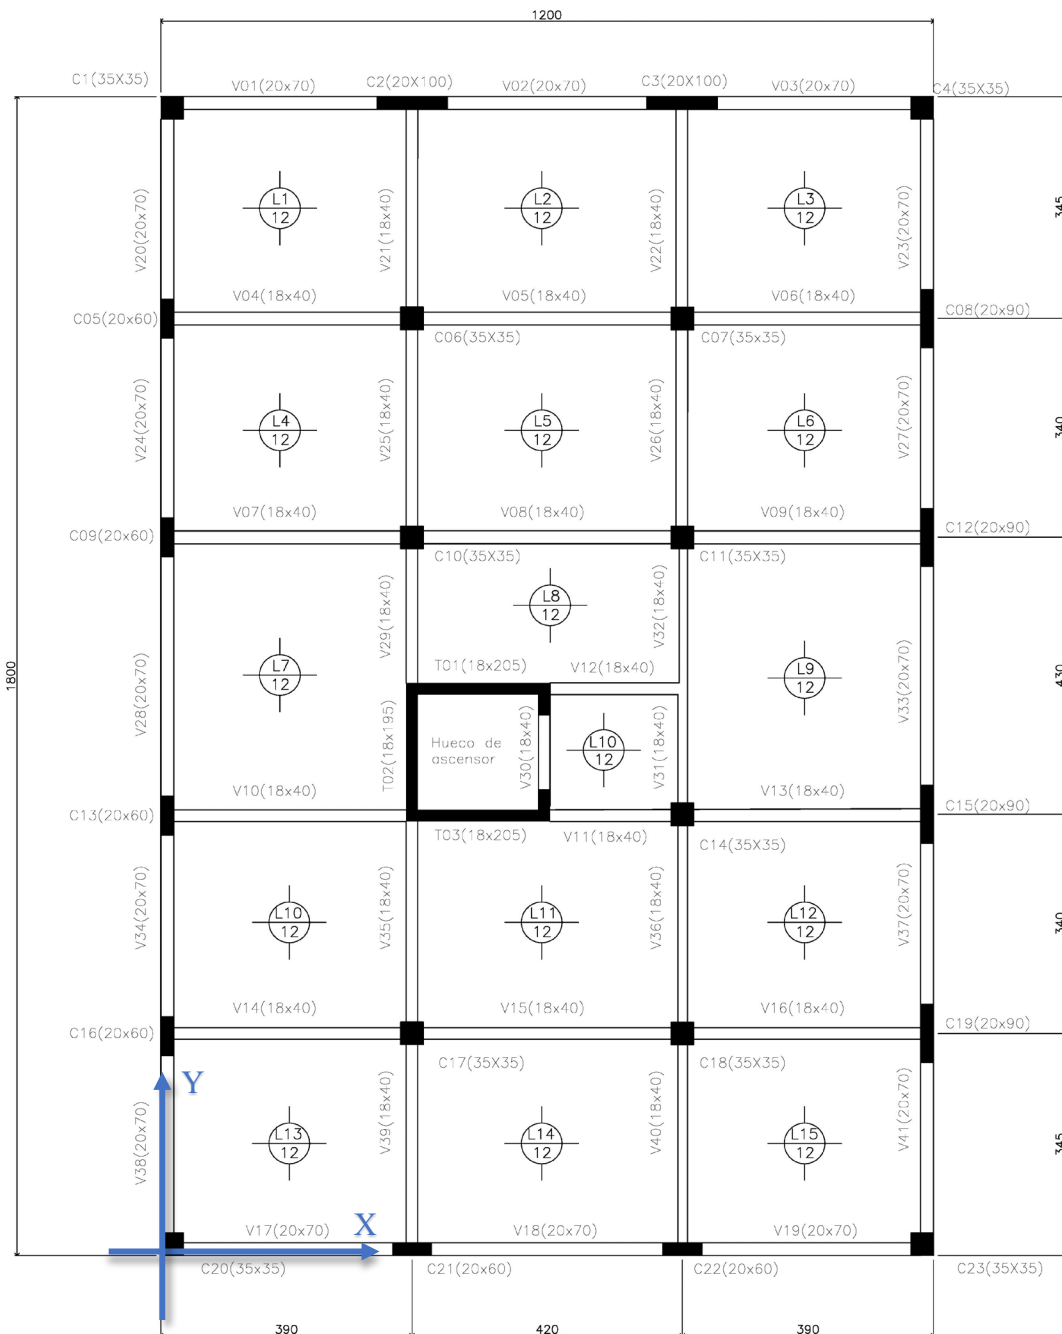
Planta resultado del predimensionamiento. X e Y ejes globales de la estructura.
